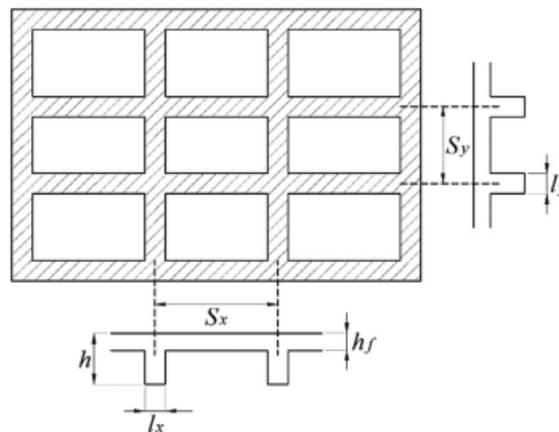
Losa de hormigón tipo Waffle (Lago et al., 2019)
